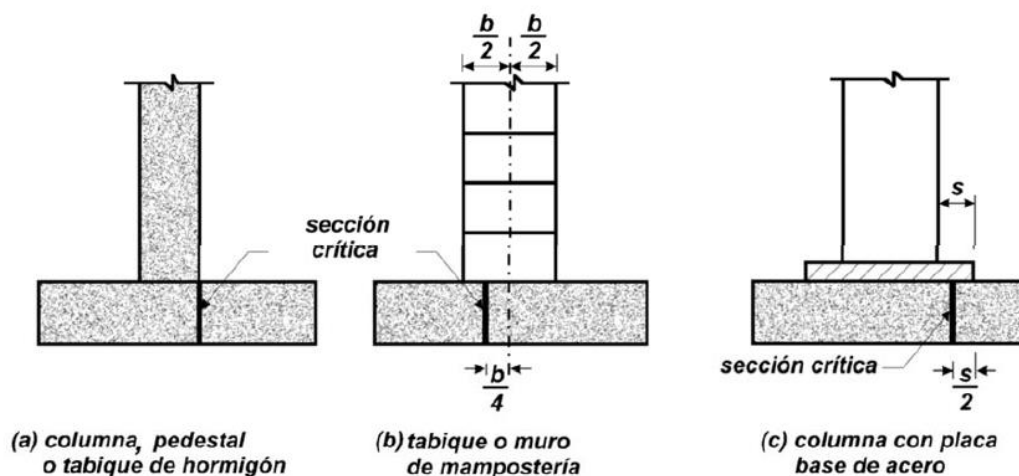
Ubicación de las secciones críticas para momento máximo mayorado en zapatas y cabezales.
